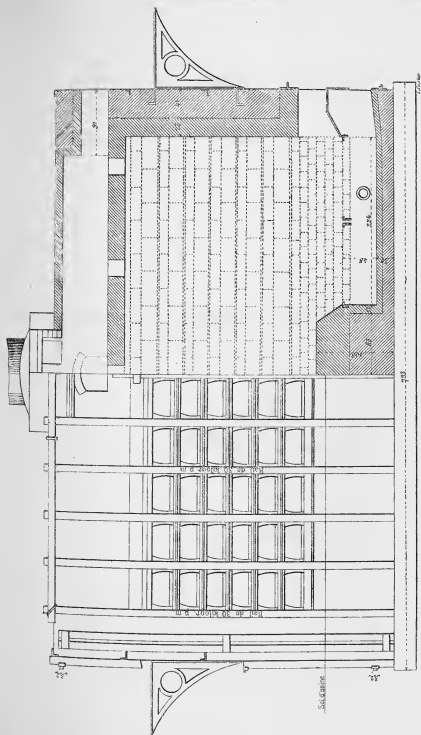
Four belge à grille Wetherill. — Coupe horizontale et vue de la devanture.
